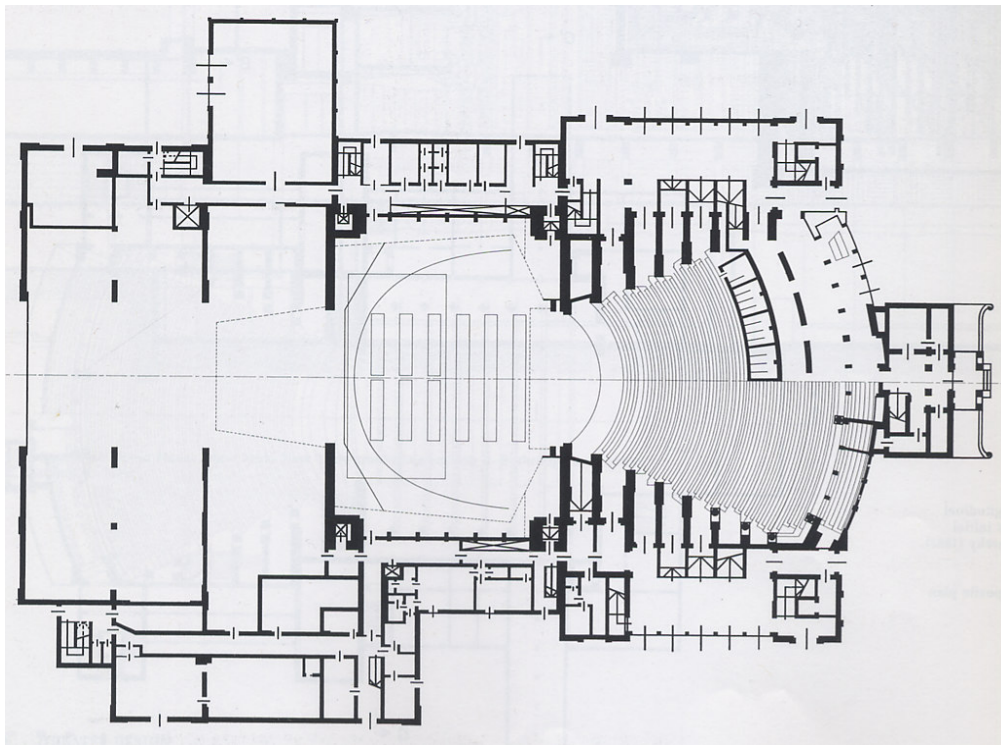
Pianta del Bayreuth Festspielhaus dopo la ricostruzione del 1974.
